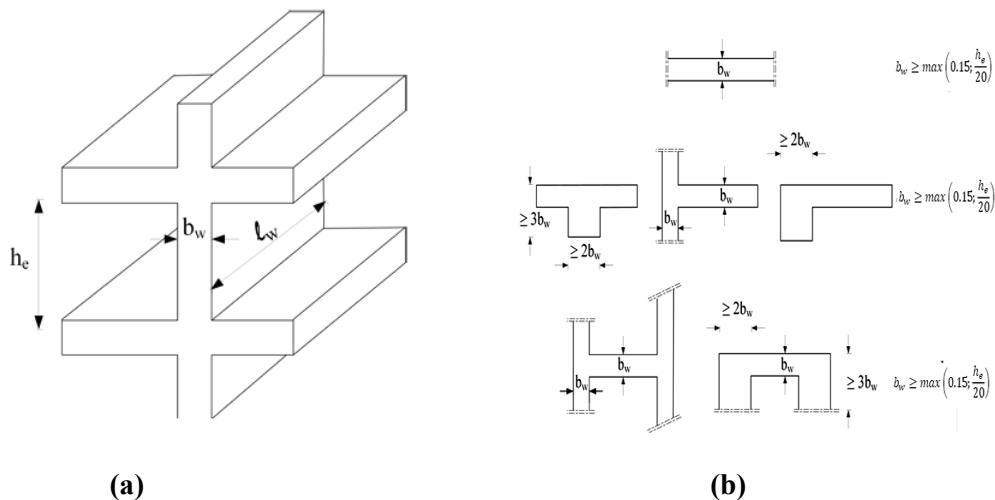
(a) Coupes de voiles en élévation , (b) Coupes de voiles en plan. (RPA, 2024)
